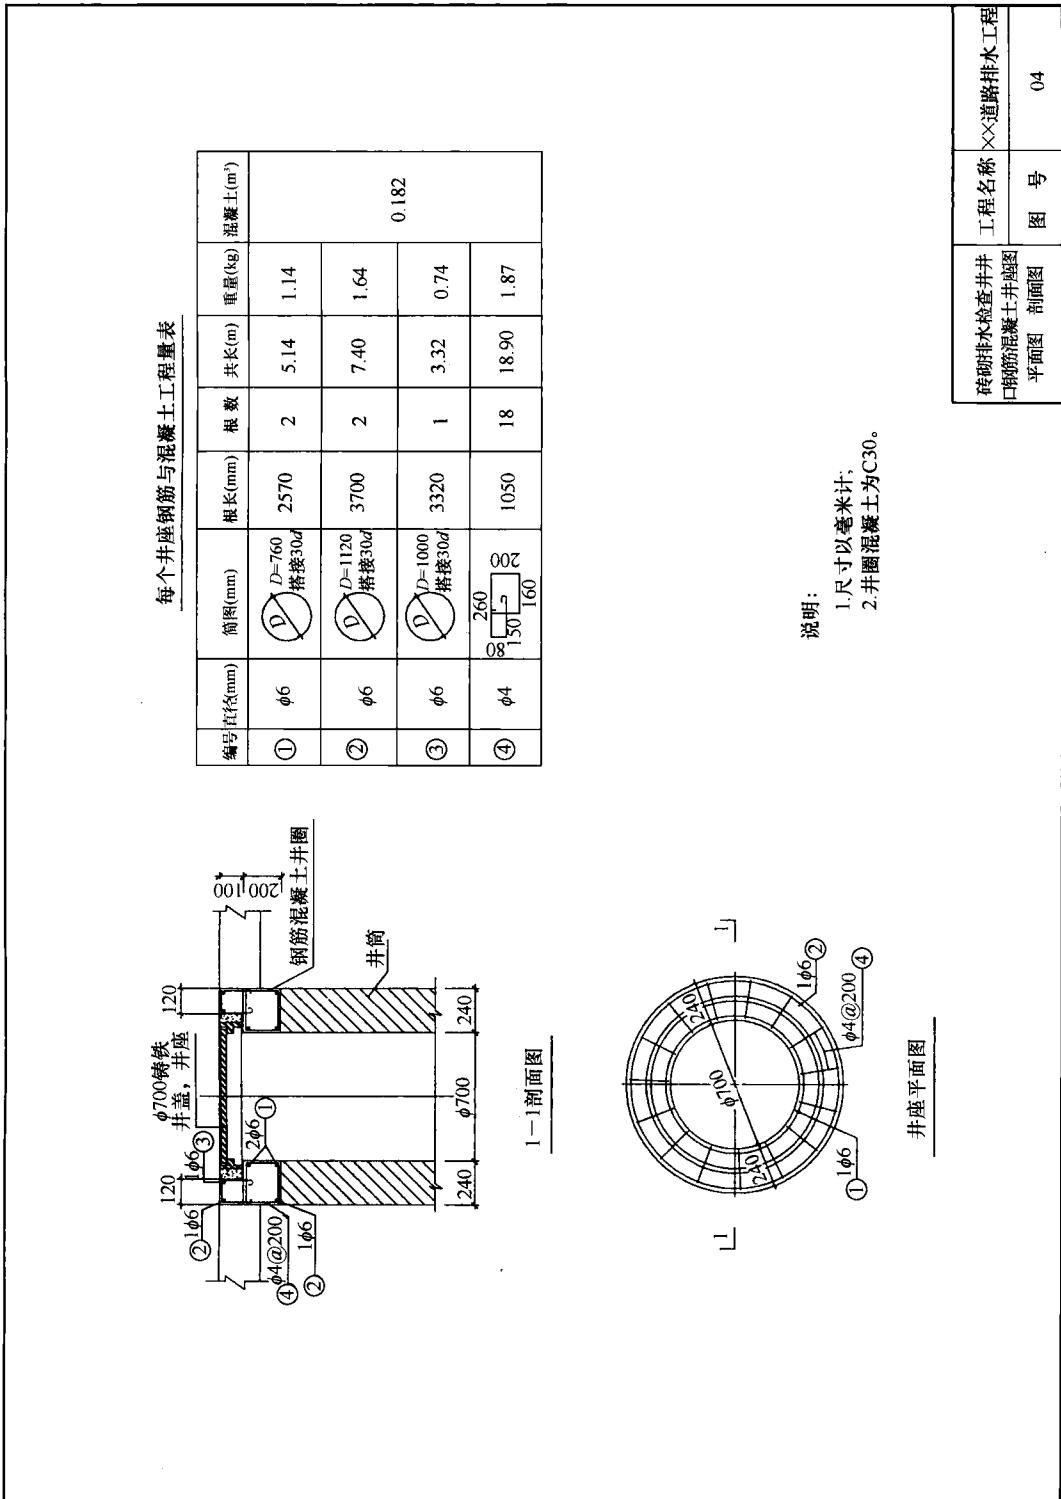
砖砌排水检查井井口钢筋混凝土井座图平面图、剖面图
